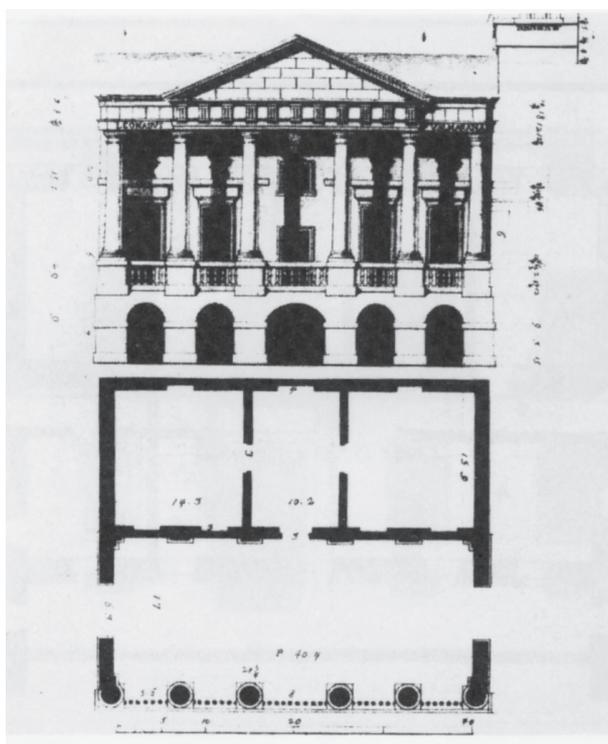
Palladio. Planta y fachada principal de la Loggia Valmarana (Vicenza).
